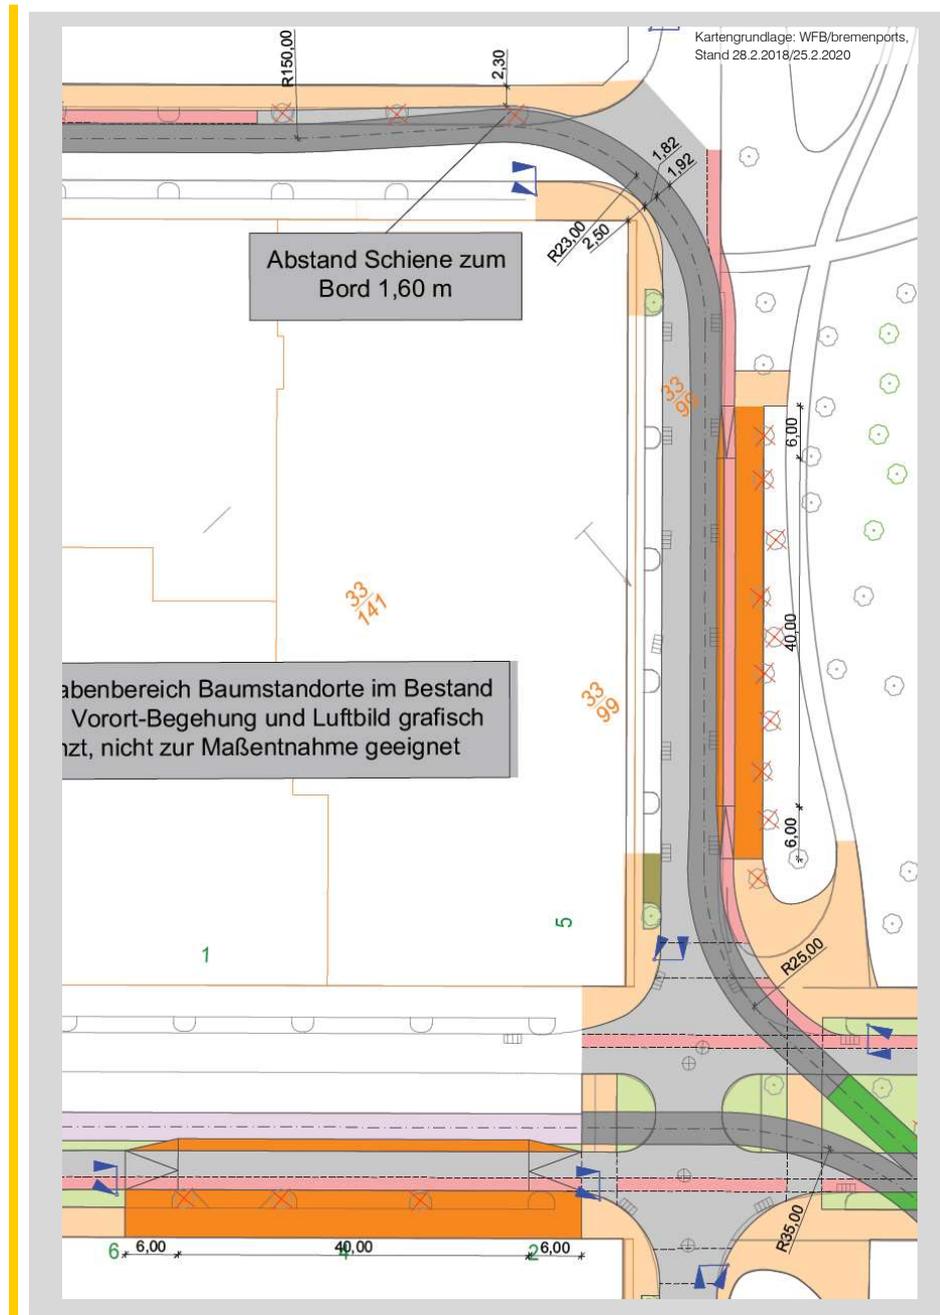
Ausschnitt Lageplan Birkenfelsstraße
